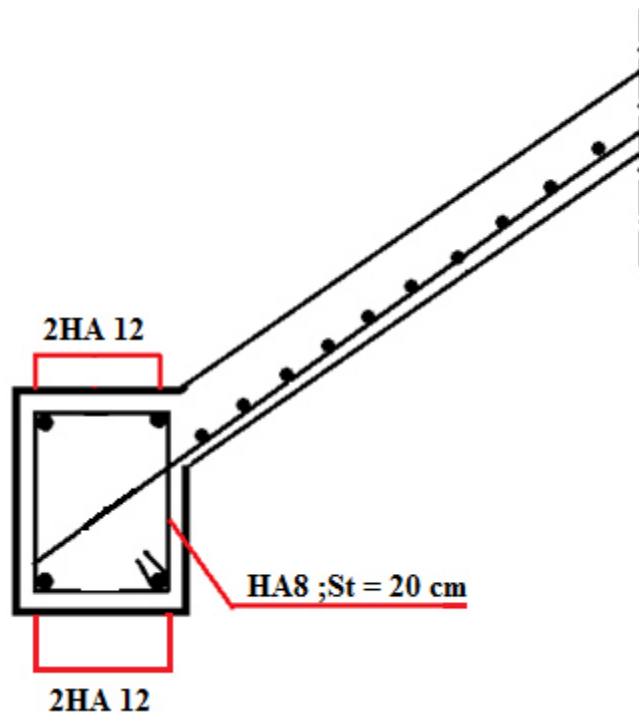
Schéma du ferrailage de la poutre de ceinture.
